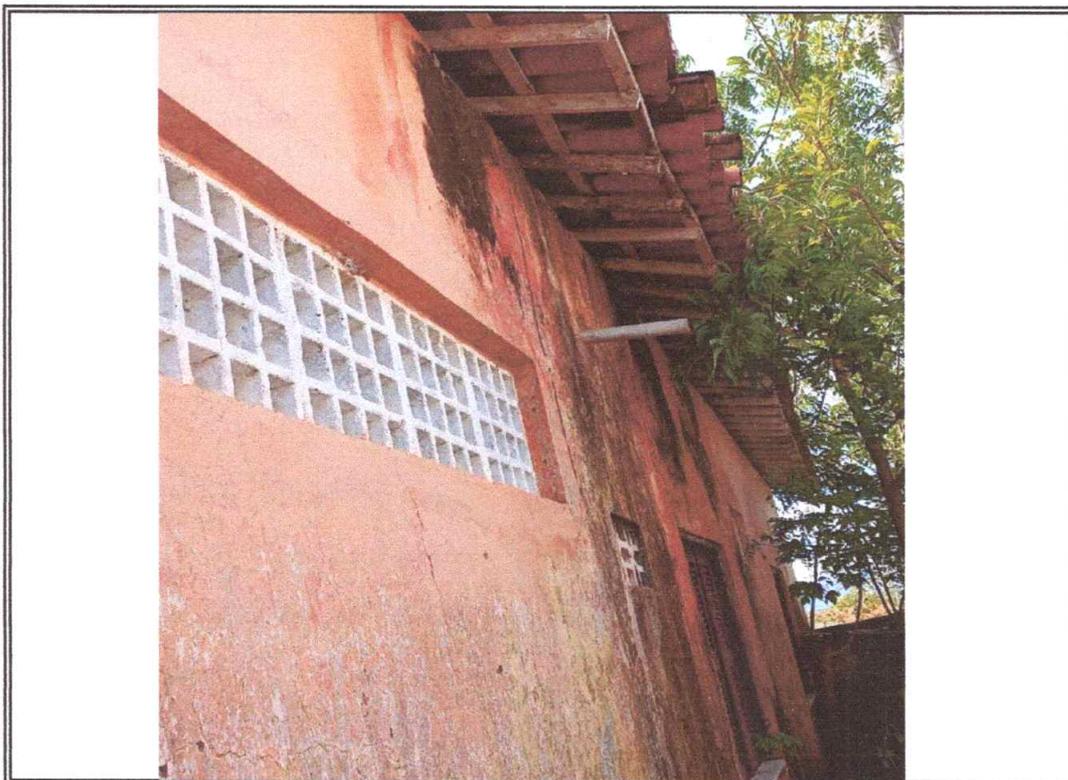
Vista do local se desativará a caixa d'agua e haverá demolição de laje.
